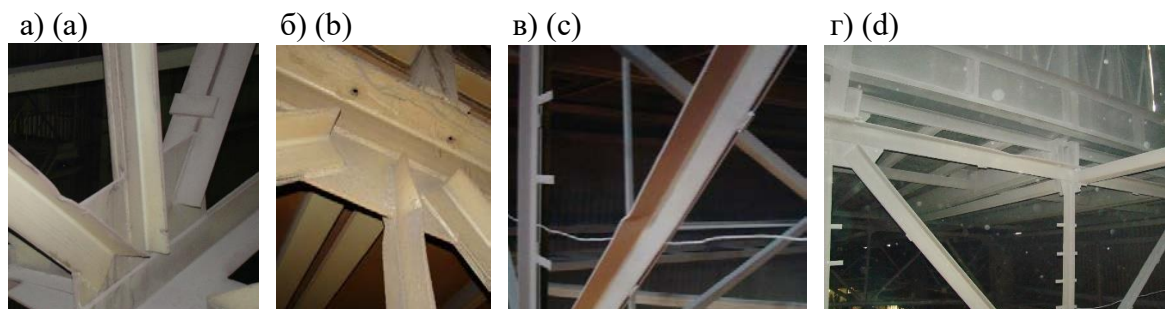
Местные искривления: отстоящей полки уголка раскоса Р3 фермы Ф15' со стороны оси 14' вблизи нижней фасонки (а); отстоящих полок уголков стойки С3 фермы Ф11' со стороны оси 10' и оси 12' вблизи нижней фасонки (б); отстоящей полки уголка раскоса Р3 фермы Ф9'(в); отстоящей полки уголка третьей панели (от ряда А) верхнего пояса фермы Ф10'(г)
